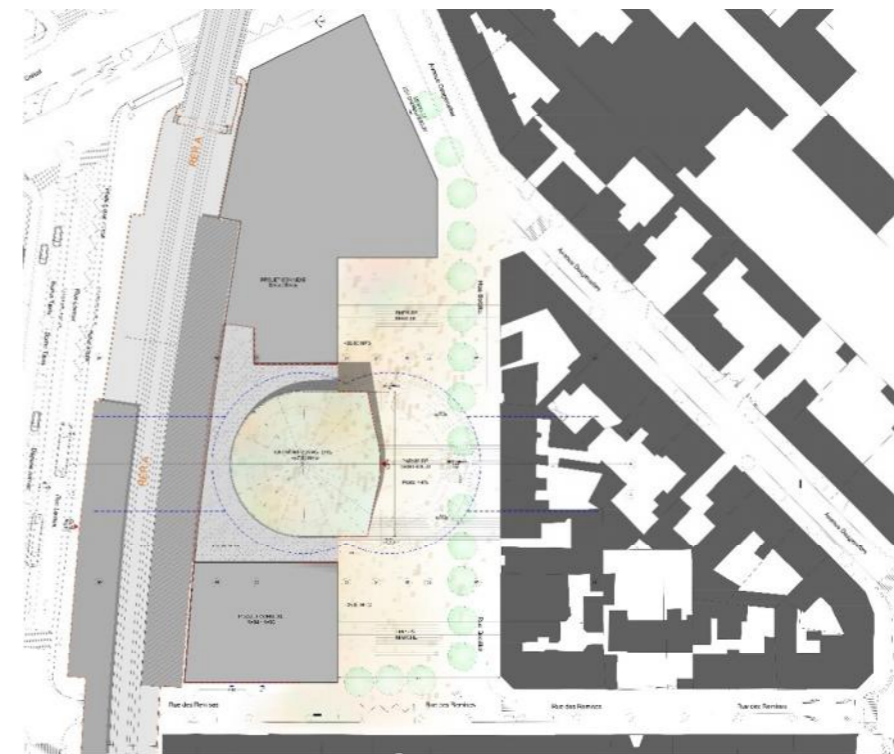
Plan de masse, Gare de Saint-Maur Créteil
